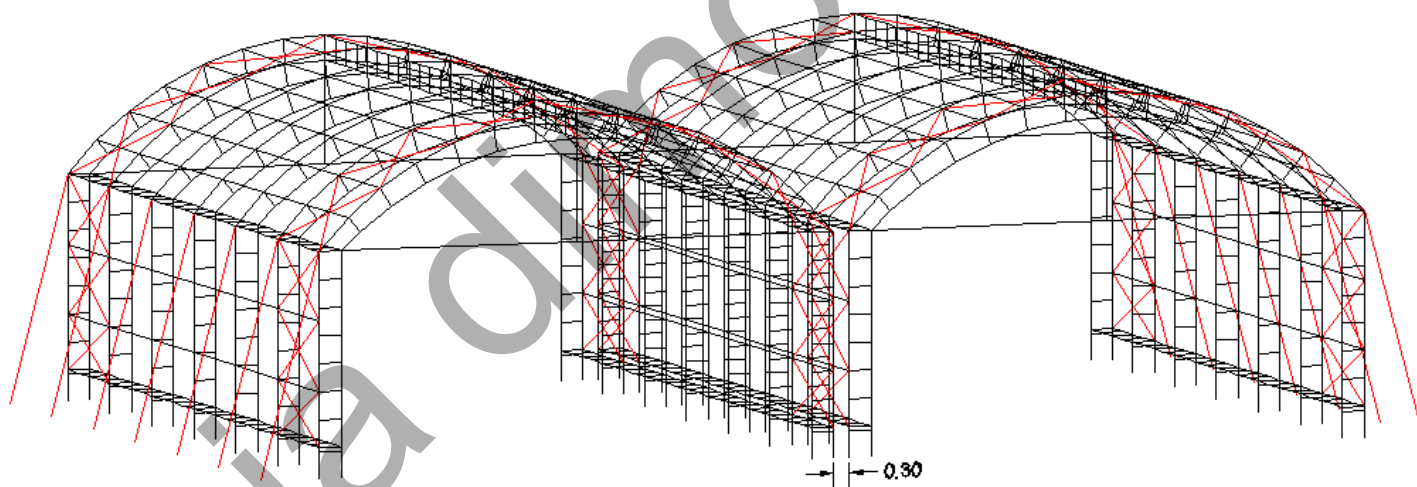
Disposizione delle strutture "gemelle": Assonometria
